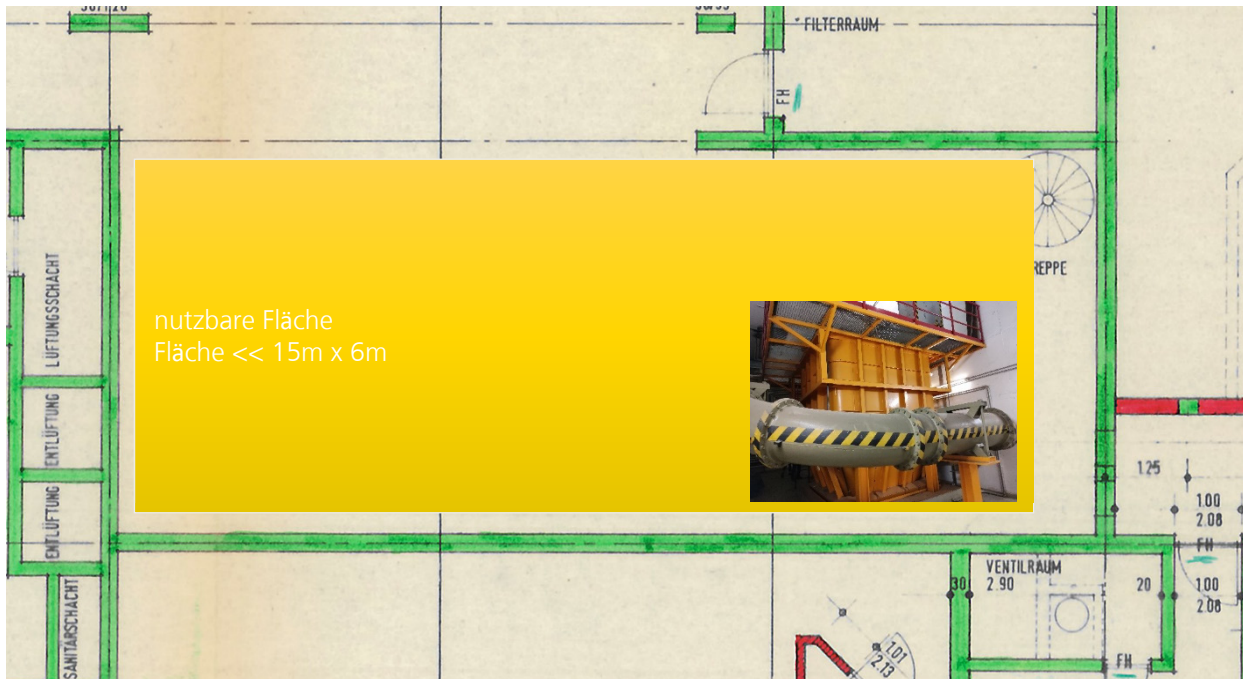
Grundriss erstes Untergeschoss – potenziell weitere nutzbare Fläche
